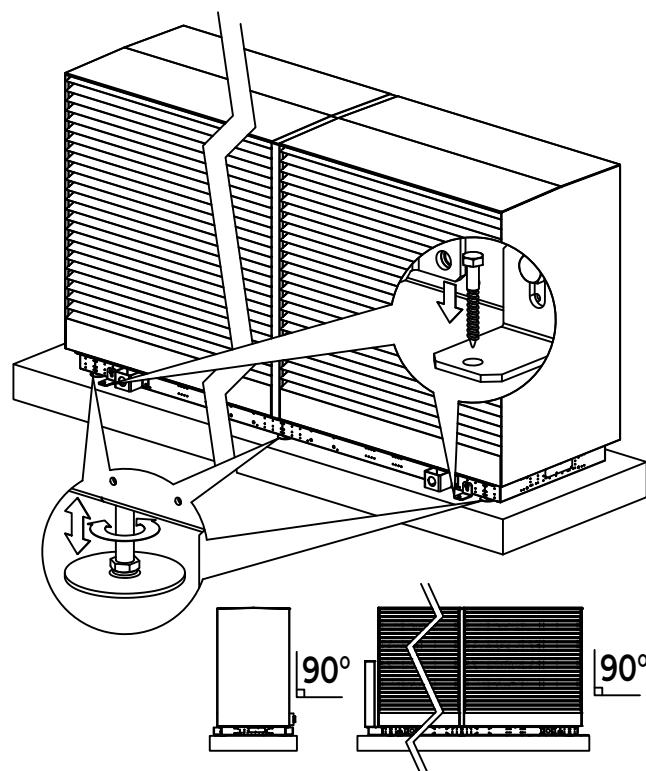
AirCalor-K K-70/-105/-140 – Installation sur la fondation et nivellement.
